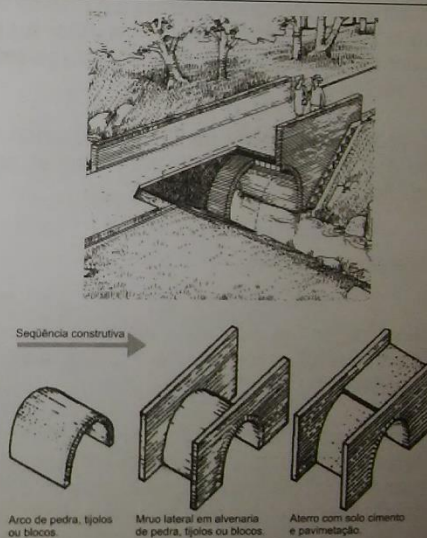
Ponte de arco, construída em alvenaria de pedras ou tijolos.
